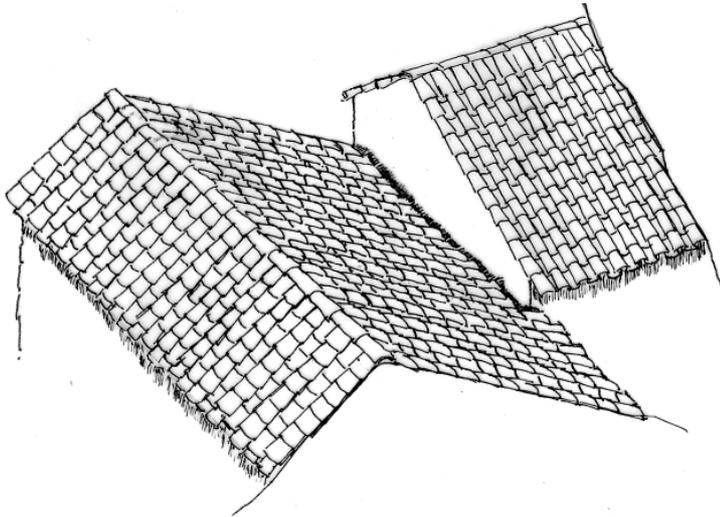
Rencontre de toiture et mur pignon donnant lieu à une incohérence dans le drainage des eaux.
